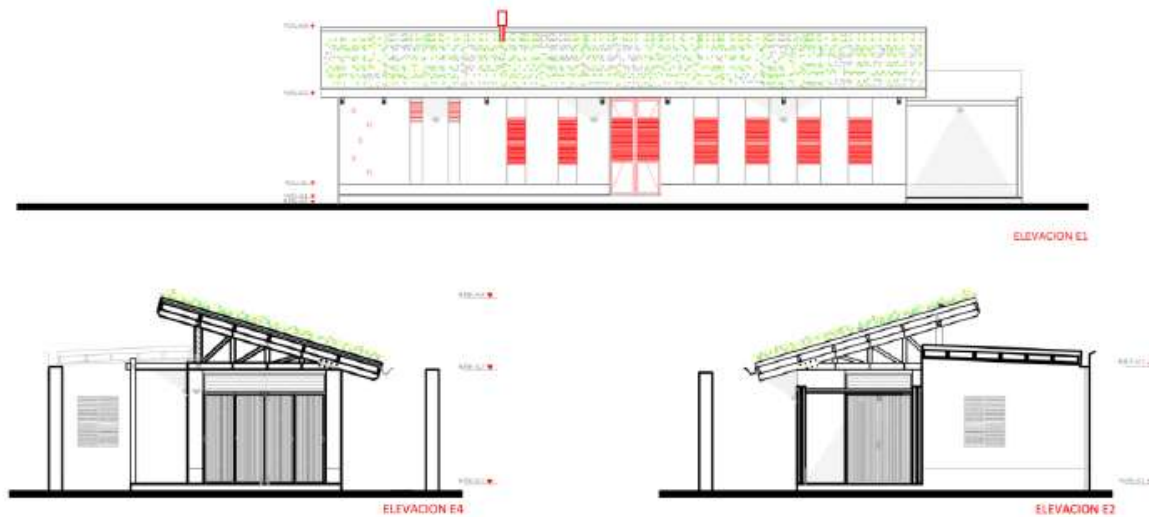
Vista de elevación de vivienda bioclimática en Chaparrí
